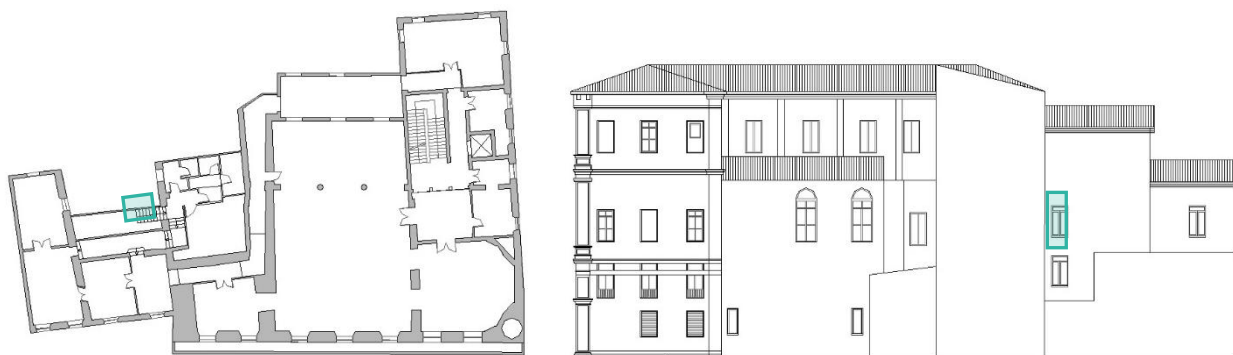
Individuazione macroelemento, pianta e prospetto
